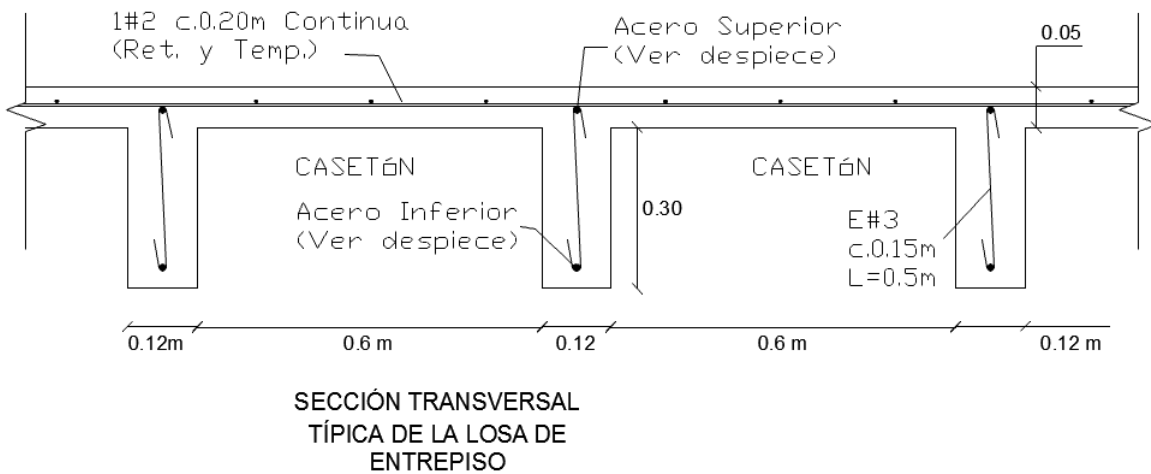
Sección transversal típica de la losa de entrepiso. Fuente. Arquitecto.
